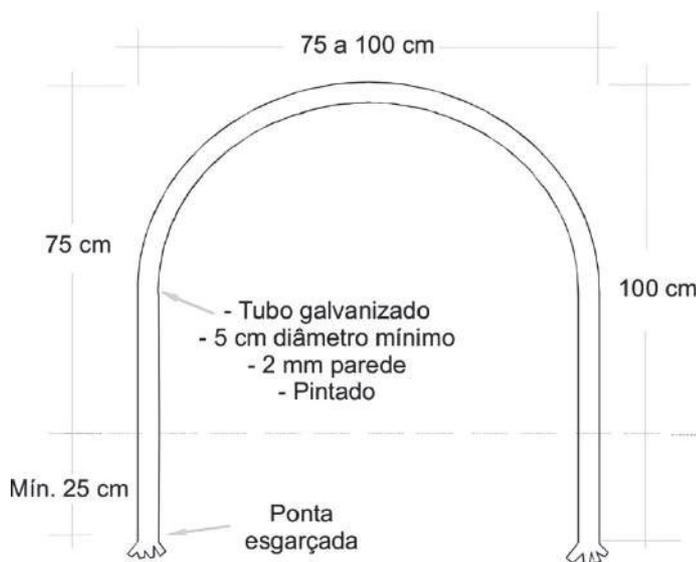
Modelo de paraciclo chumbado no pavimento.
